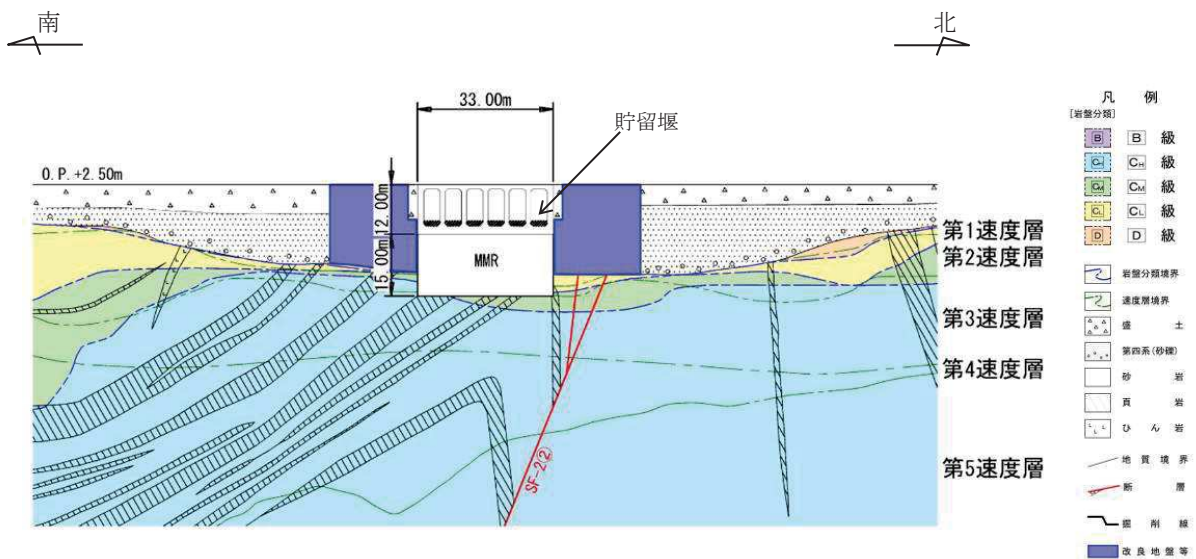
貯留堰（取水口）地質断面図（A-A）
